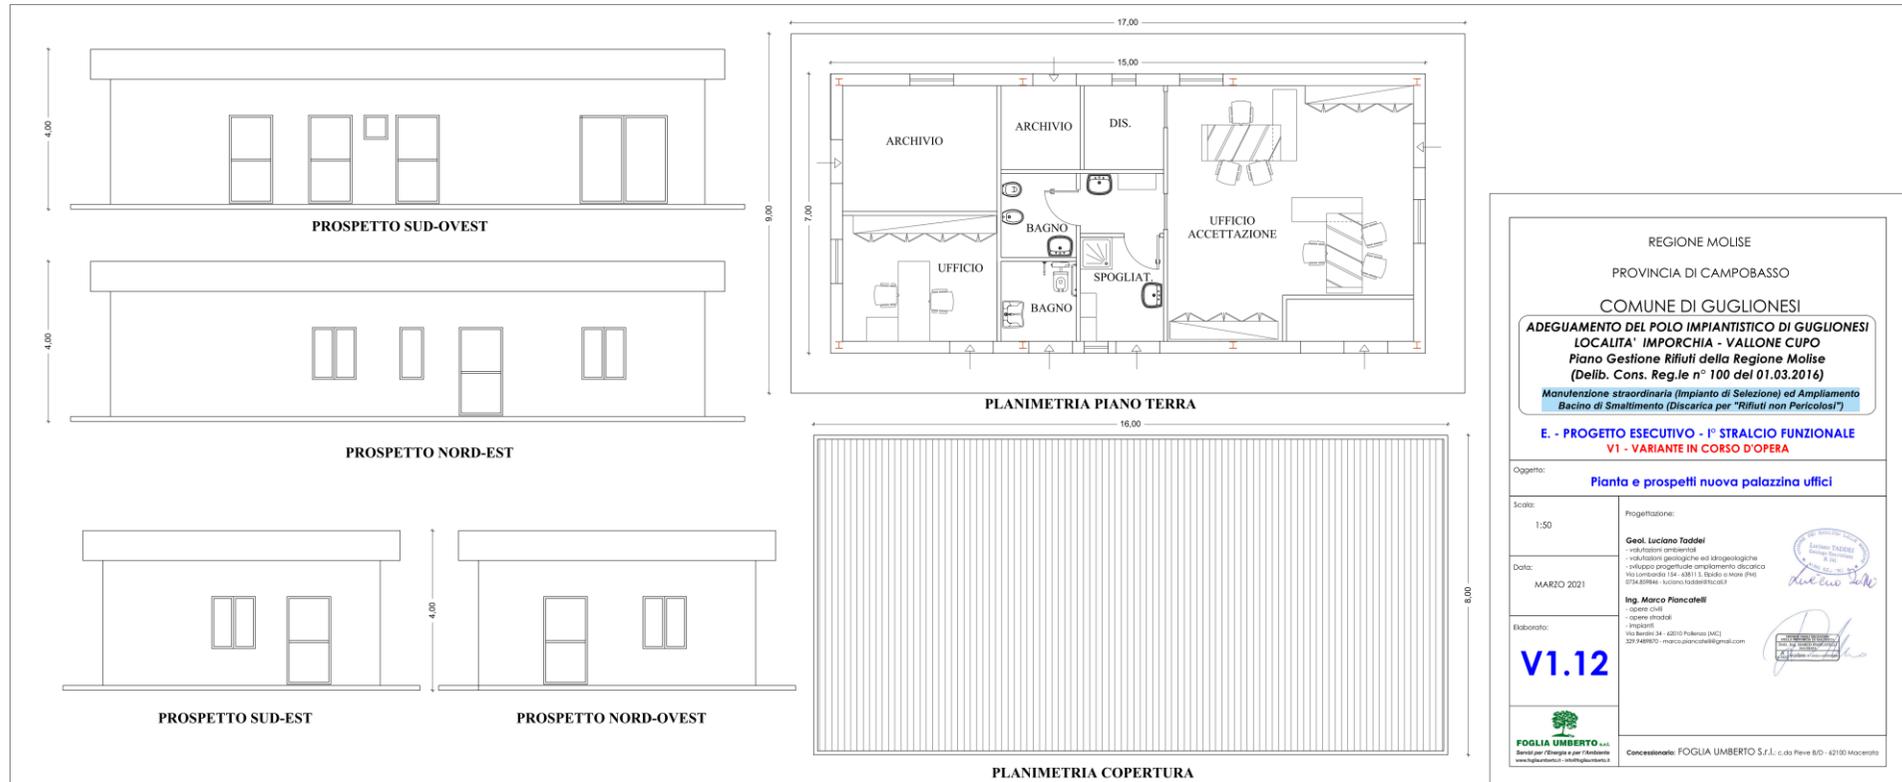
piante e prospetti della nuova palazzina: assetto "post operam"
